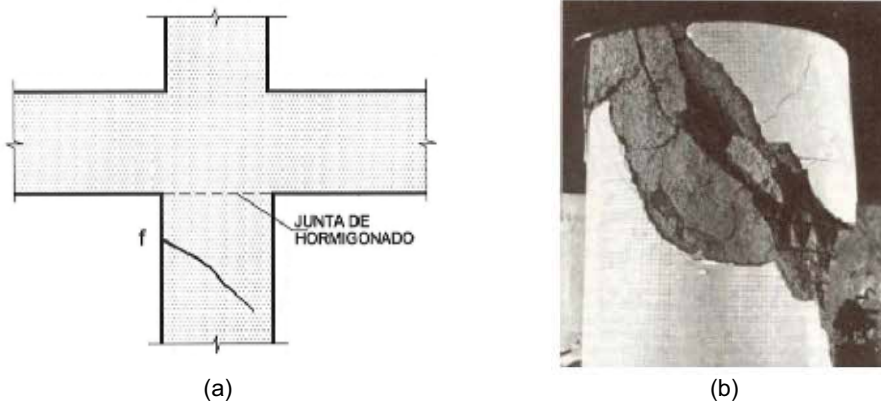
(a) Fisura inclinada en cabeza de pilar (Fuente: Calavera, 2005). (b) Pilar agotado por agrietamiento diagonal (Fuente: Estévez, 2003)
